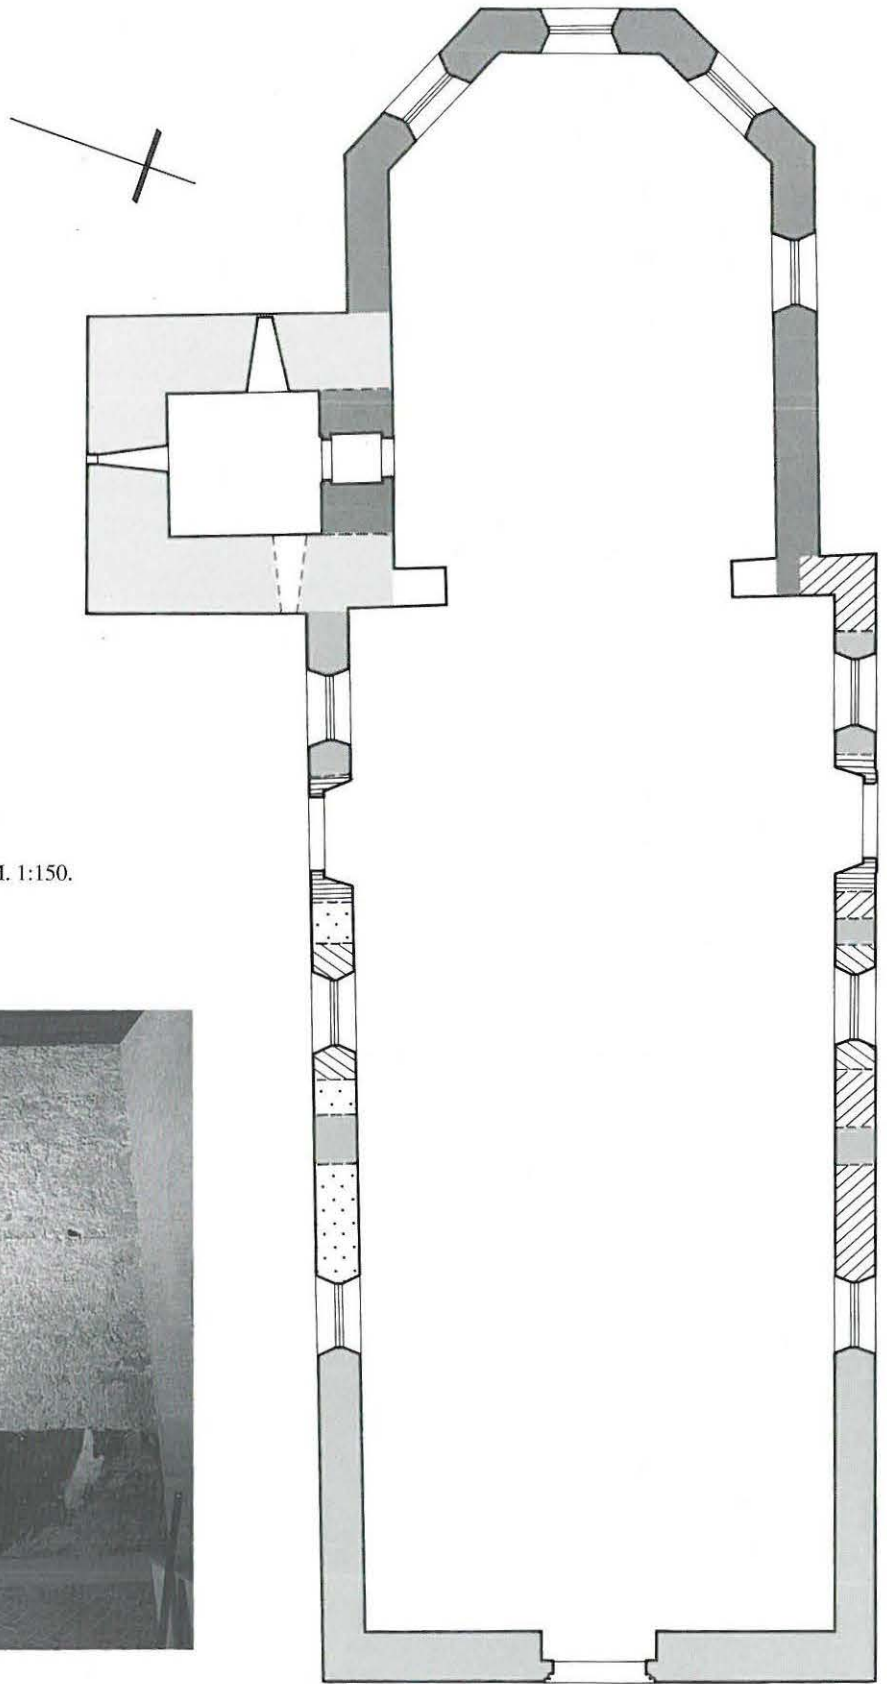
Grundriss mit Angabe der Bauperioden. M. 1:150.
